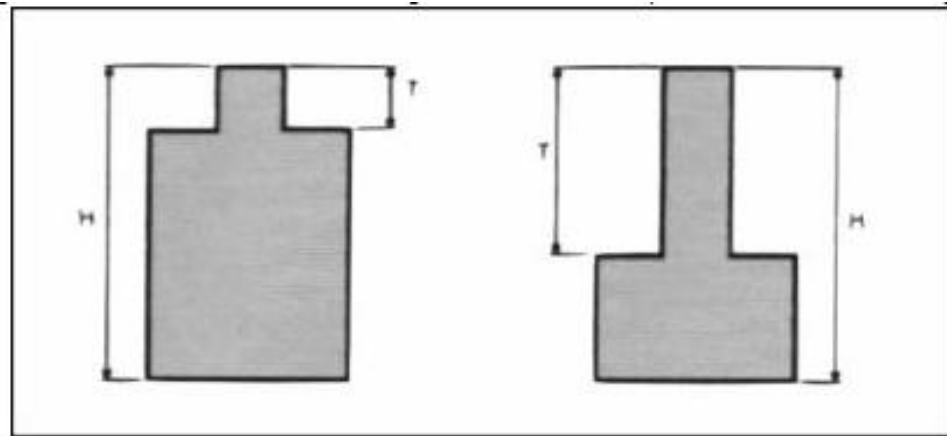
Configuración en elevación de la estructura – Chavarría (2001)
